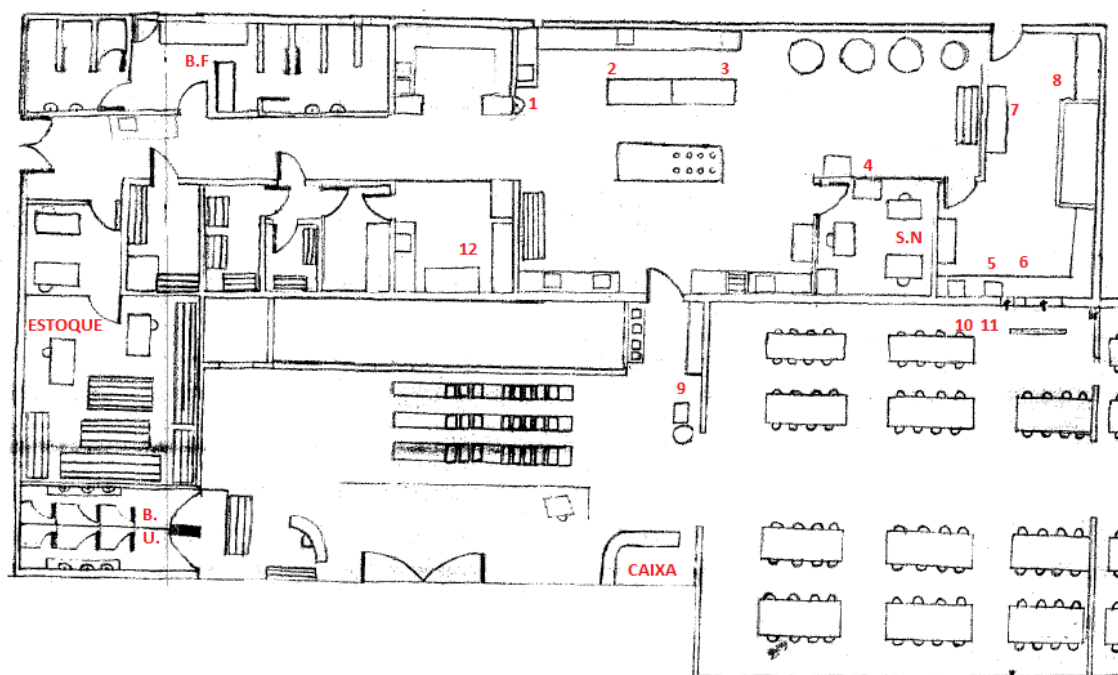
Planta baixa do restaurante com localização das lixeiras.
